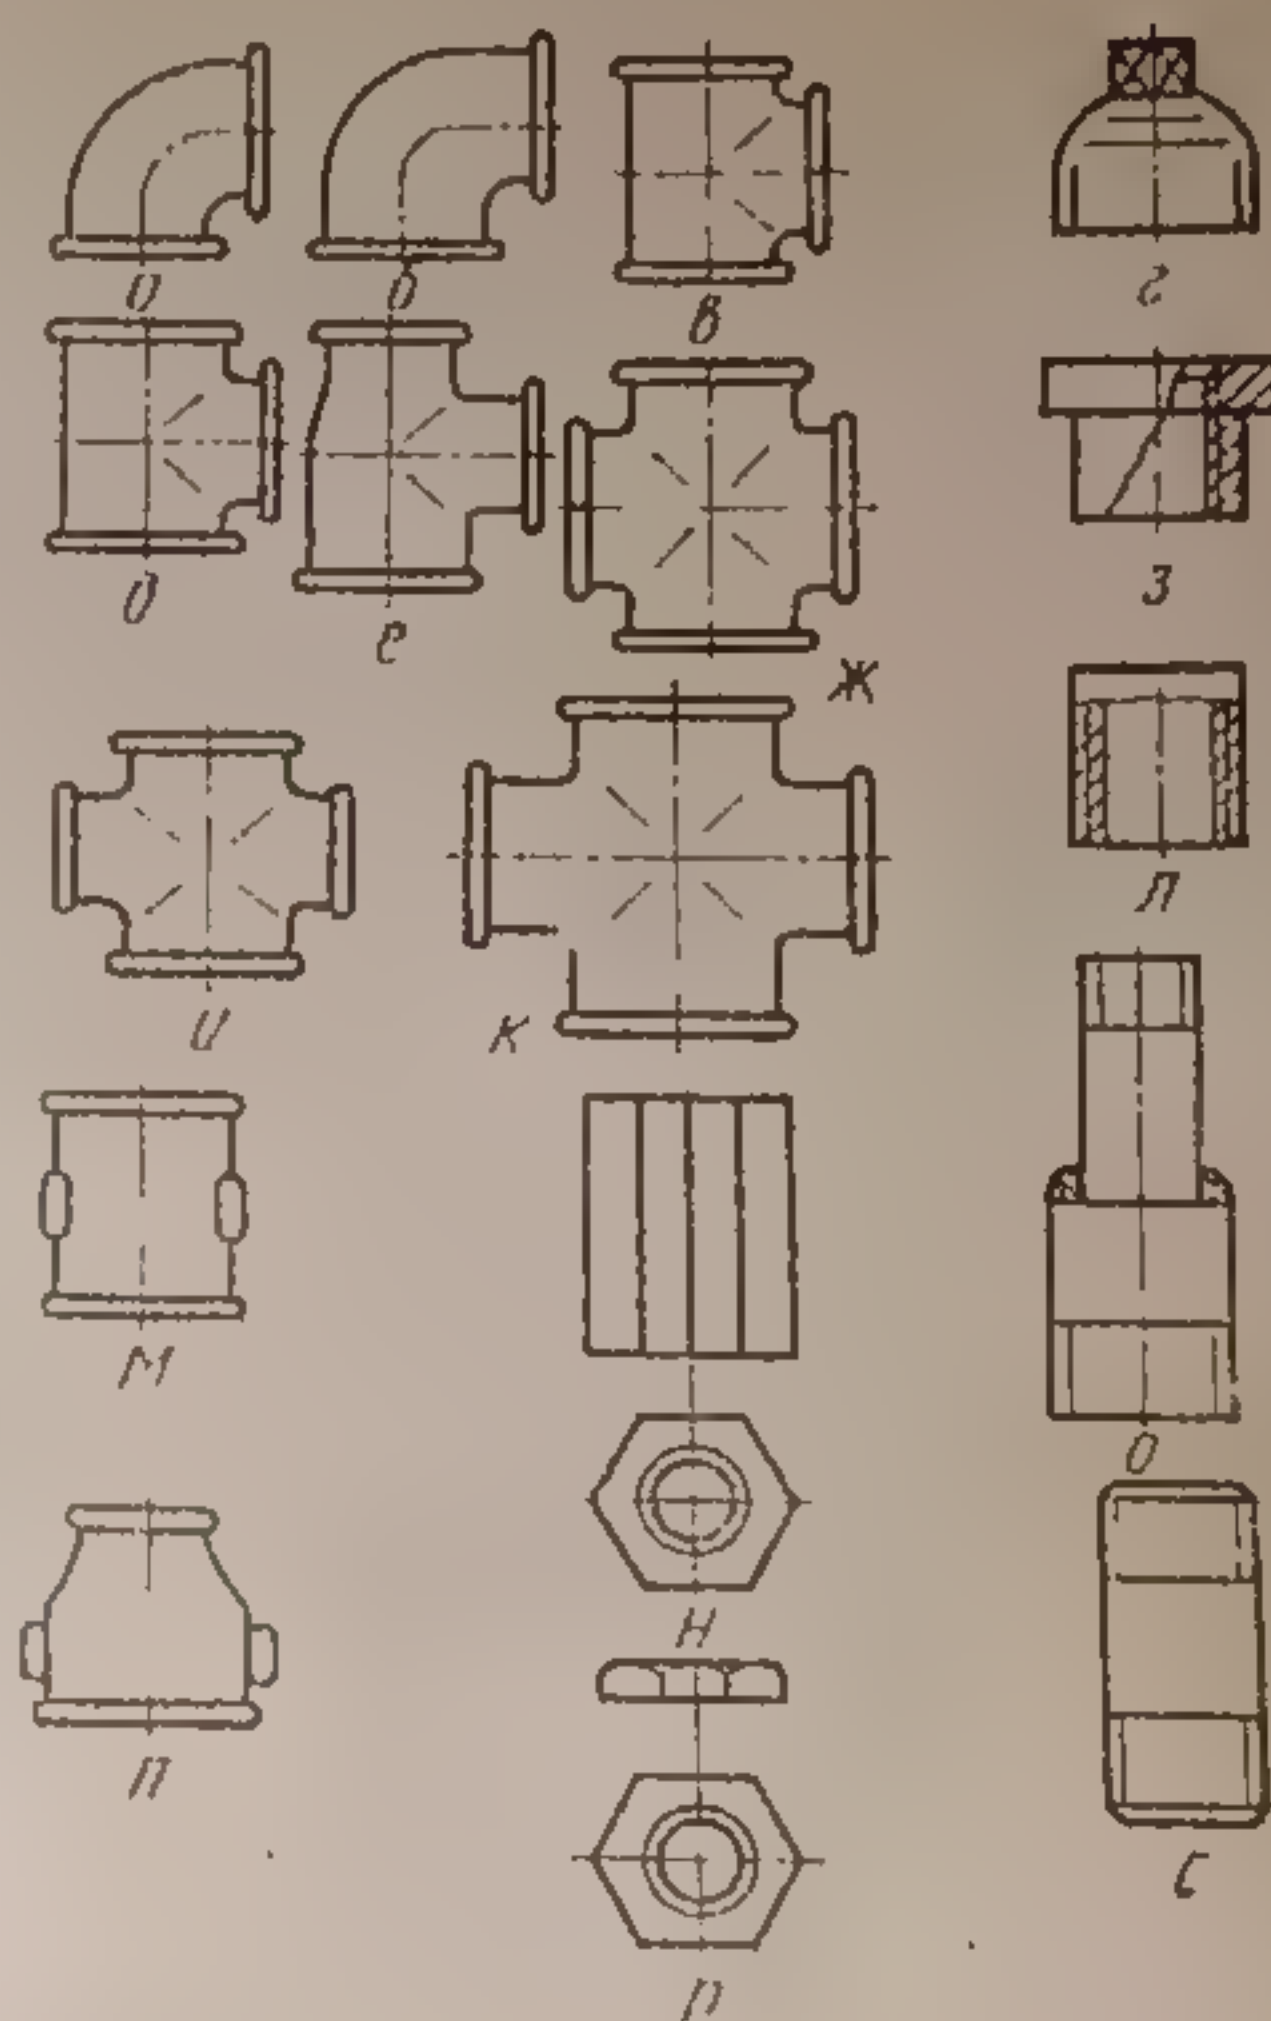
Фитинги для стальных труб: а — прямой угольник; б — переходной угольник; в — прямой тройник; г — заглушка; д — переходной тройник; е — тройник с двумя переходами; ж — прямая крестовина; з — футорка; и — переходная крестовина; к — крестовина с двумя переходами; л — самодельная заглушка из трубы; м — муфта из чугуна; н — муфта пластмассовая; о — переходник сварной; п — муфта переходная; р — контргайка; с — бочонок
